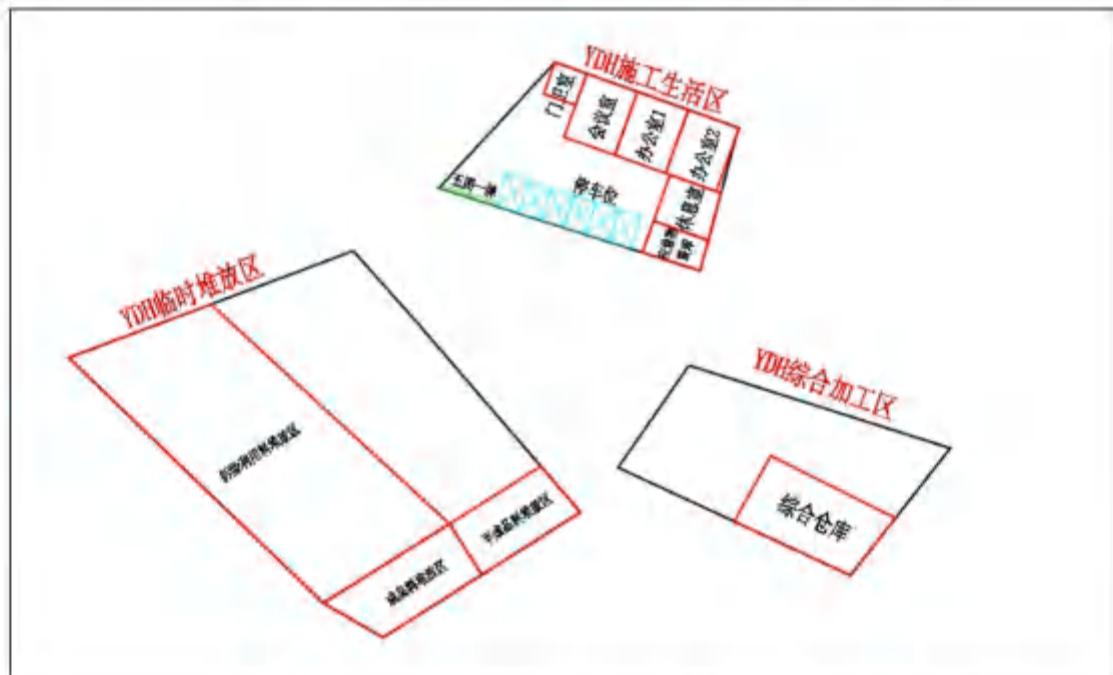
永定河河口左堤段生产生活区平面布置图
